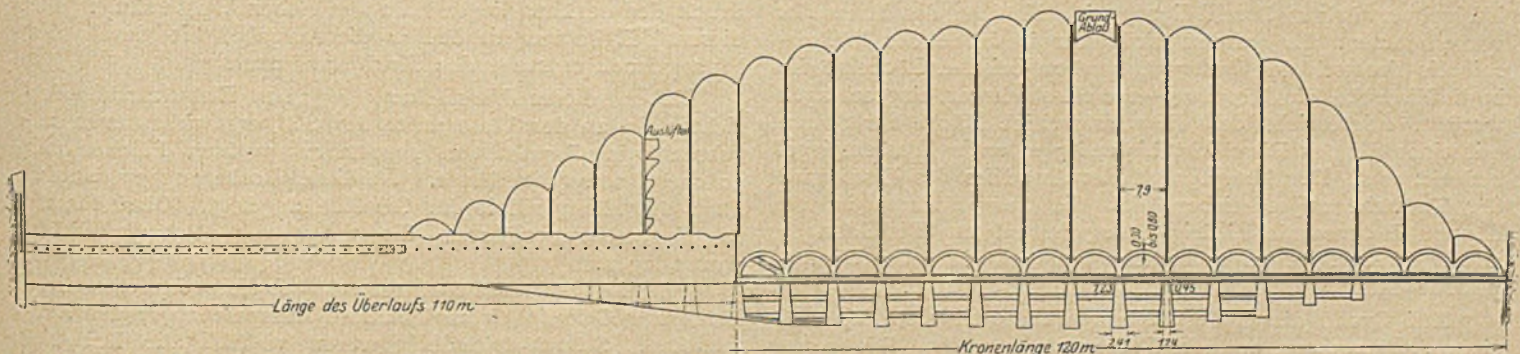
d. Grundriß einer Eisenbetontalsperre.
